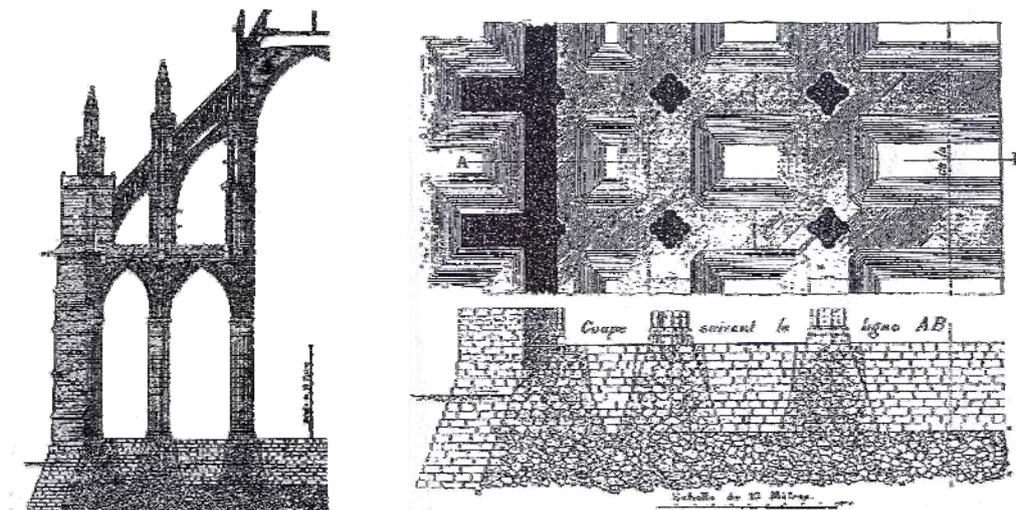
Planta y alzado de la cimentación de la Catedral de Amiens.
